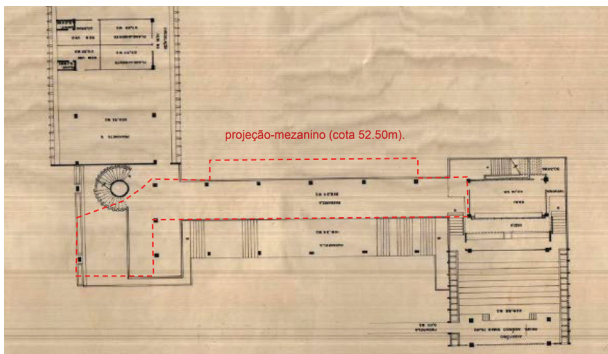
| Planta Baixa (cota, 49,00m), escadas e projeção-mezanino (cota 52,50m)
